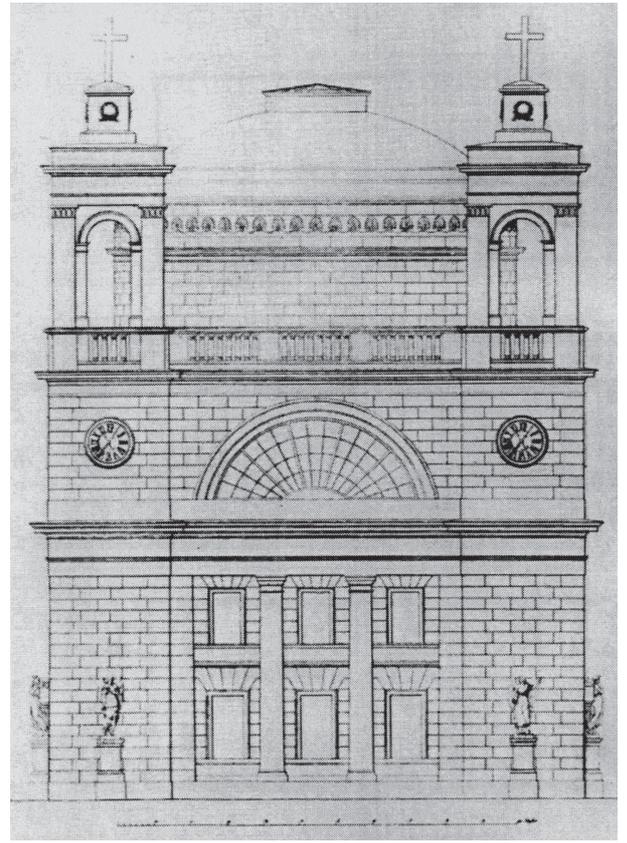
Pietro Nobile, prospetto posteriore (1823).
